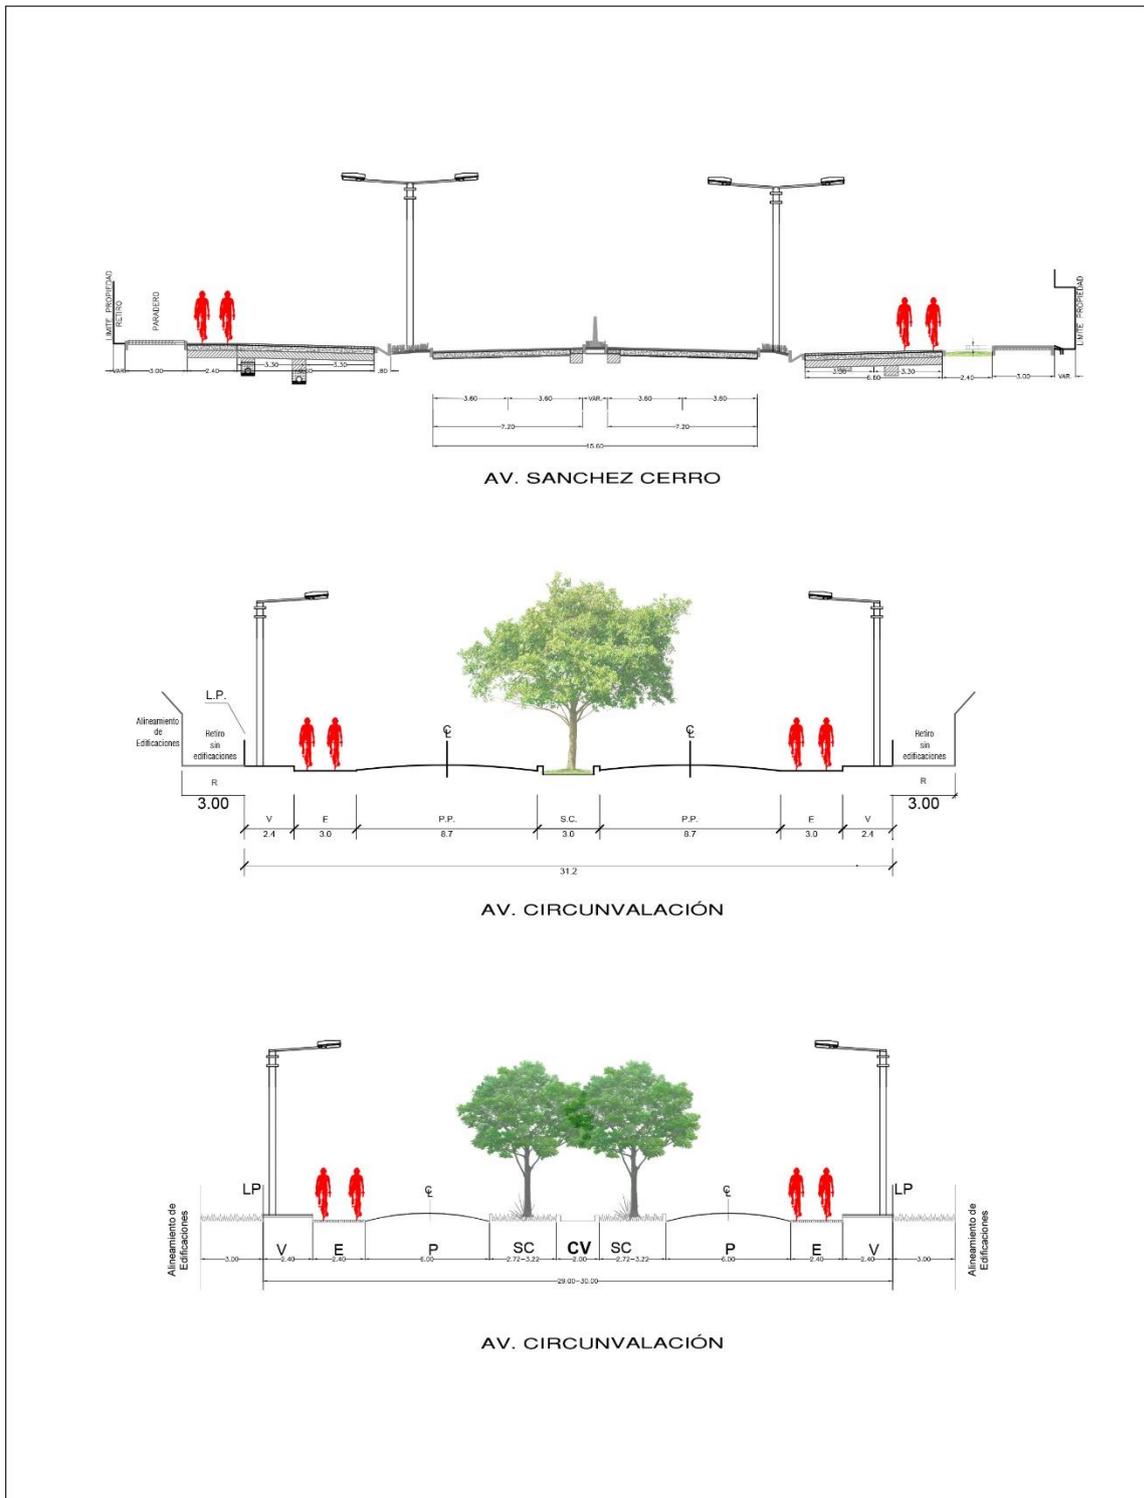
Secciones de vías que se Plantea en el Proyecto Como un Plan Rector
